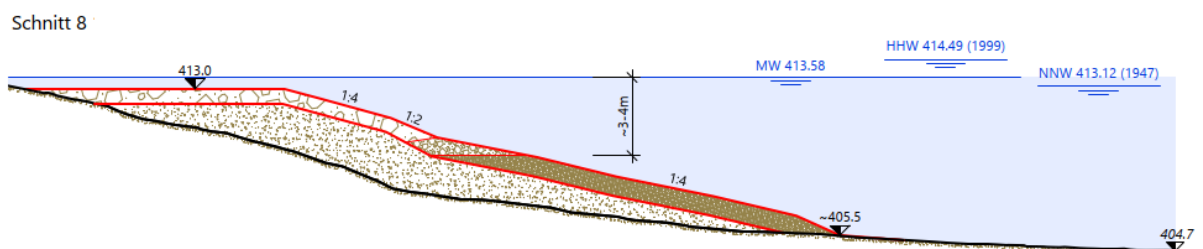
Beispielschnitt durch geplante Schüttungen, Stand Bauprojekt (August 2024)
